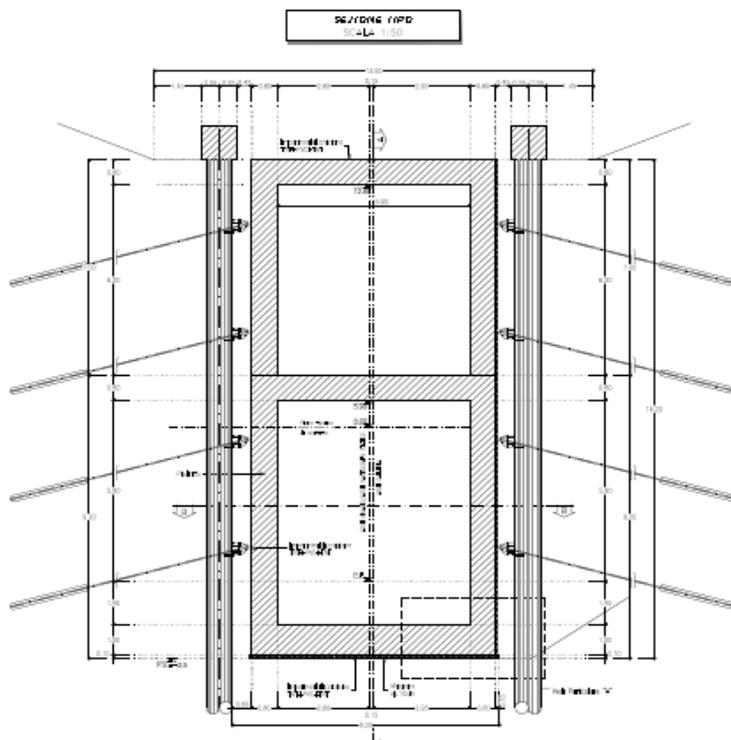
Sezione trasversale singola canna con doppia soletta di copertura GA06
